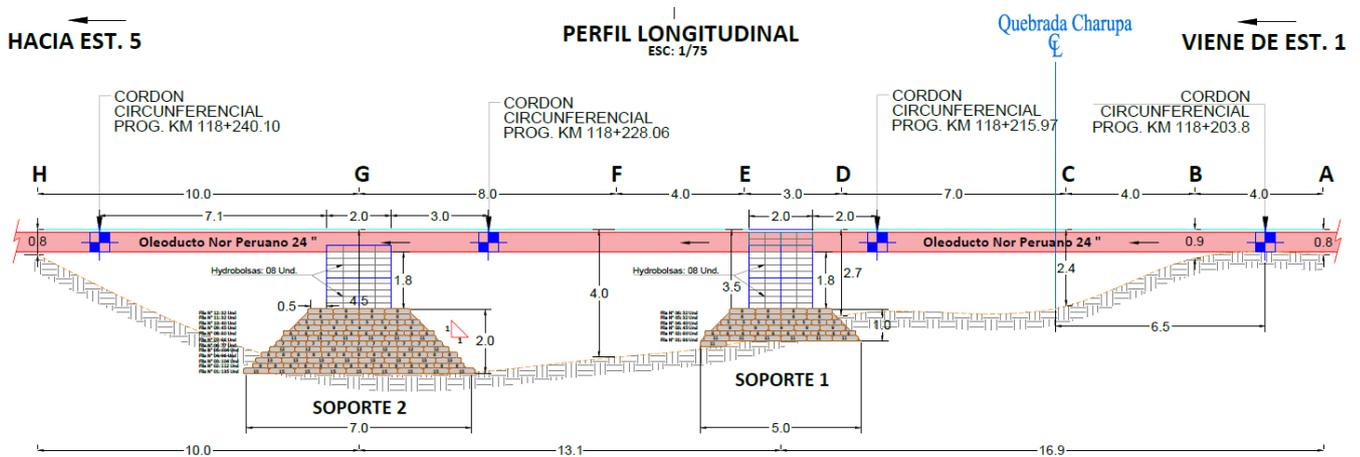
Perfil longitudinal de la tubería donde se colocarán los apoyos.
